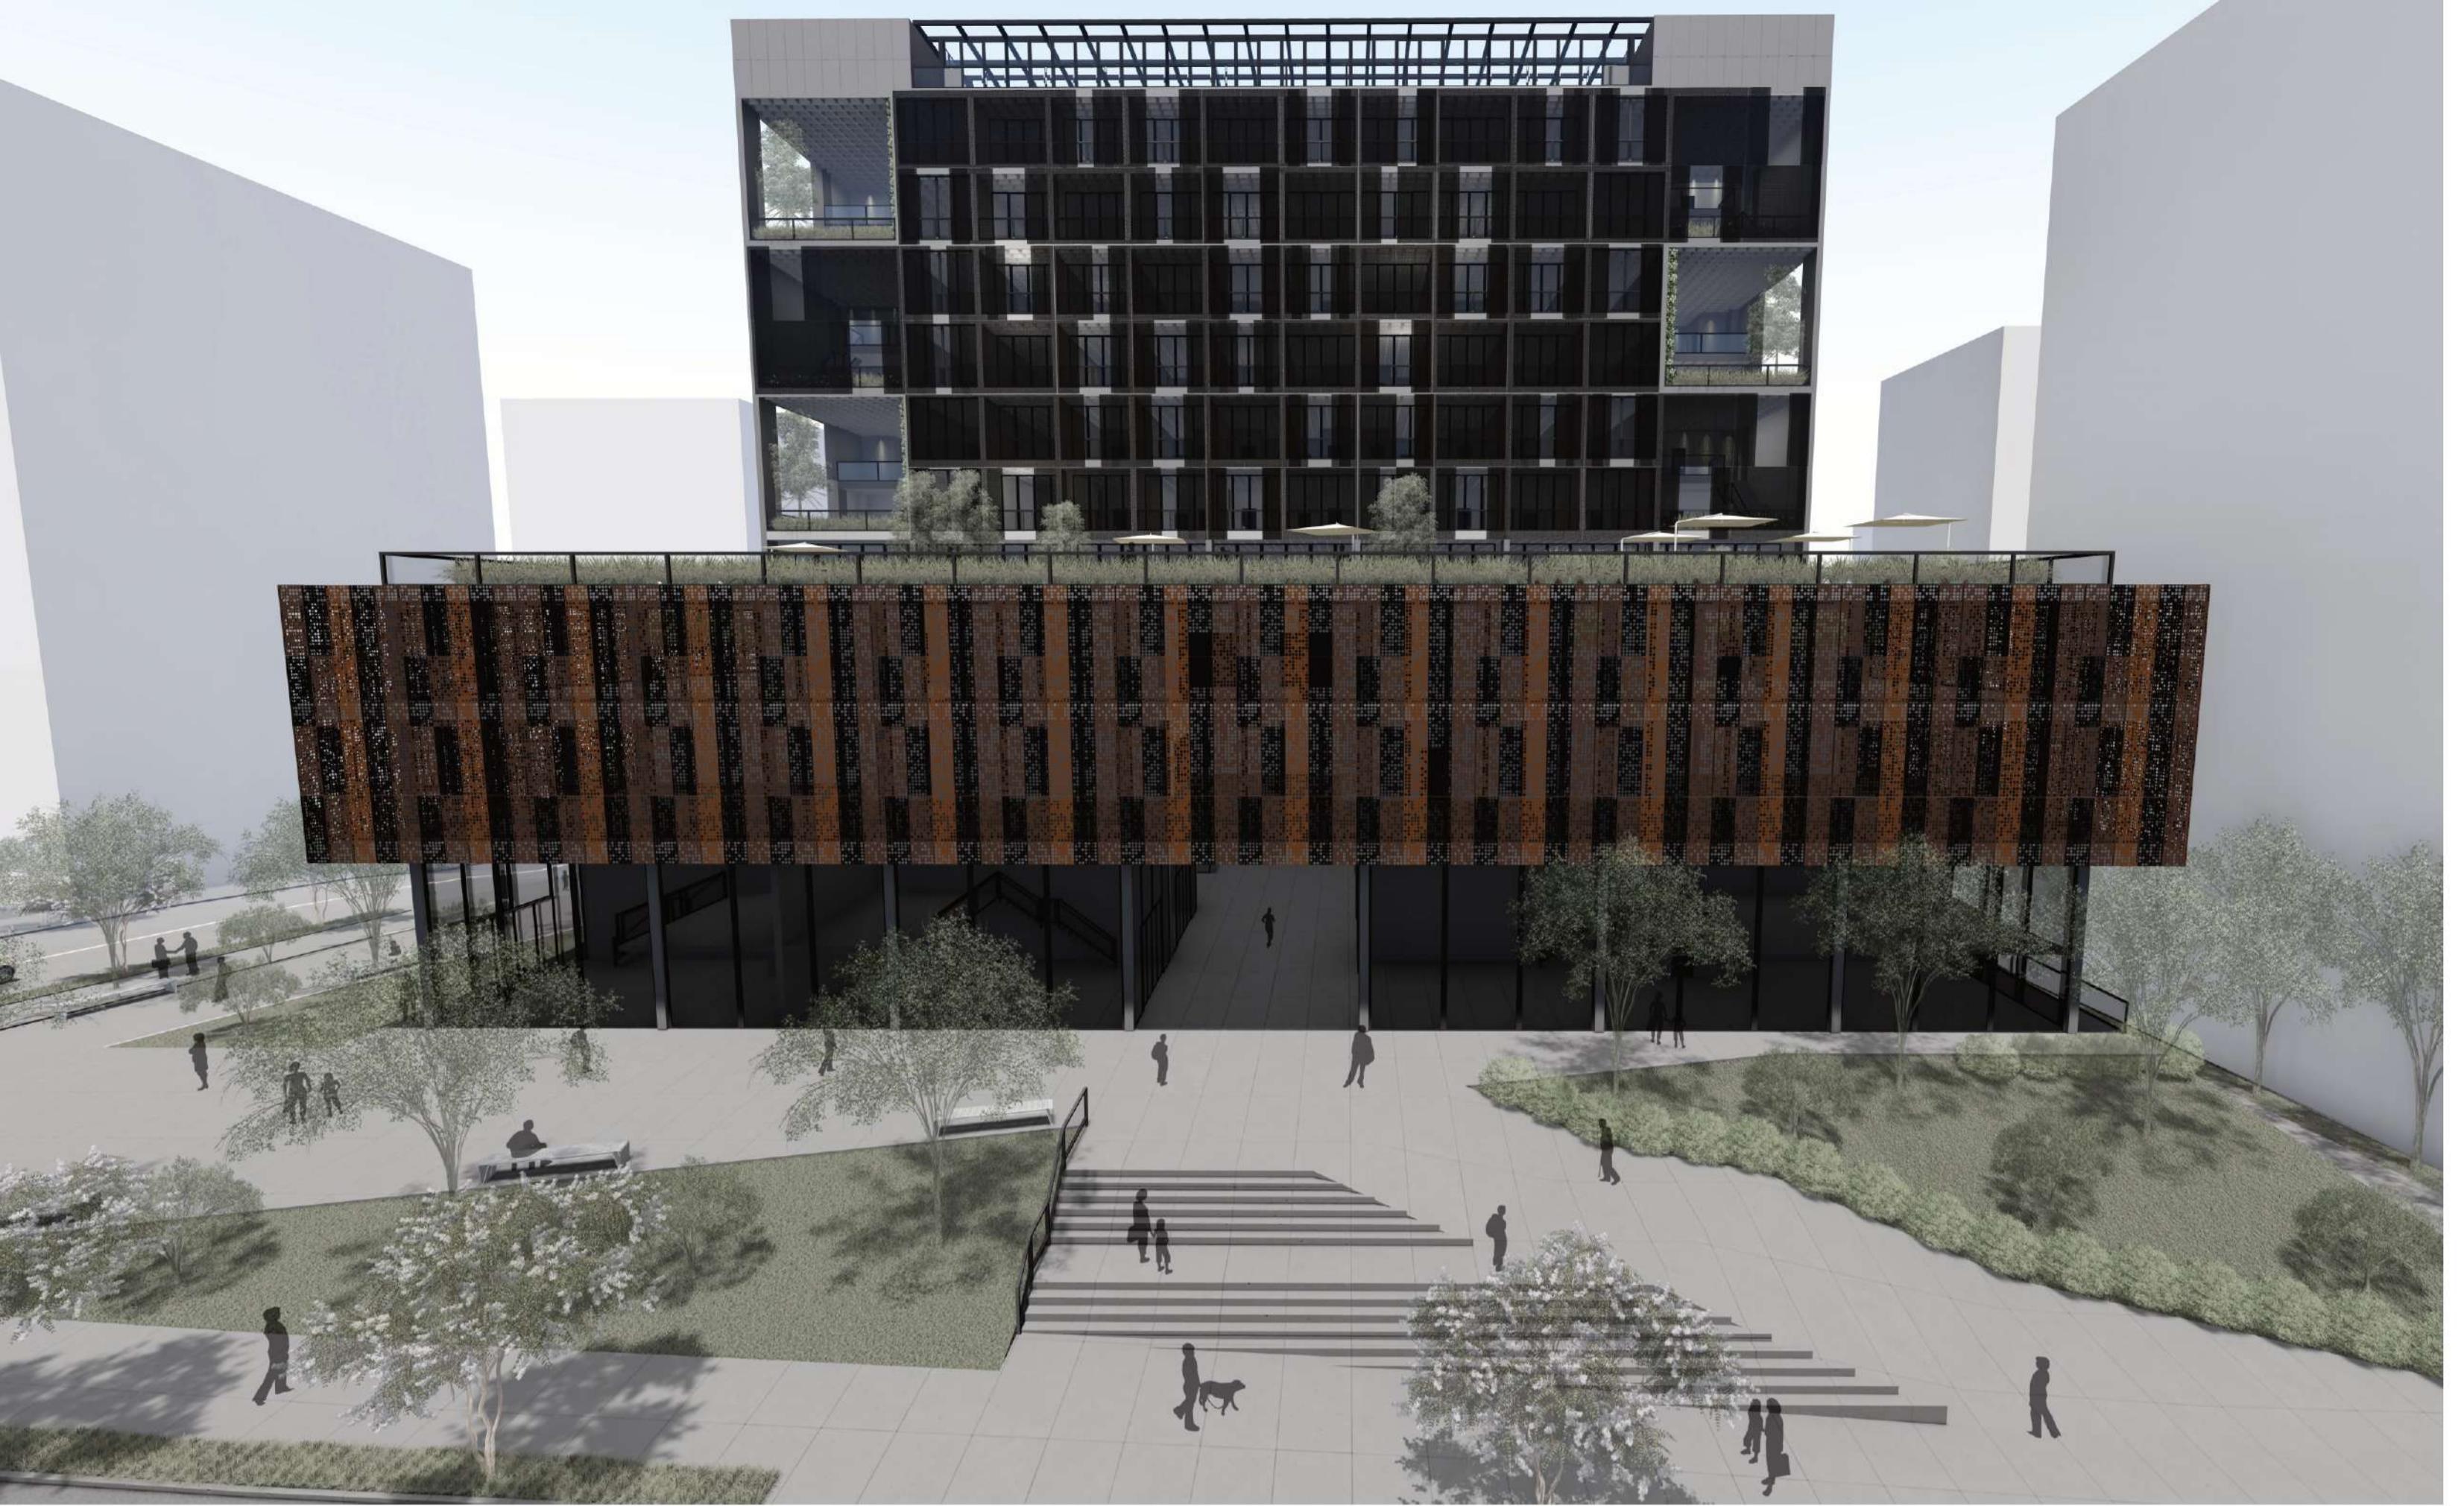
IMAGEM FACHADA LESTE, ACESSO PRINCIPAL AO EMPREENDIMENTO
